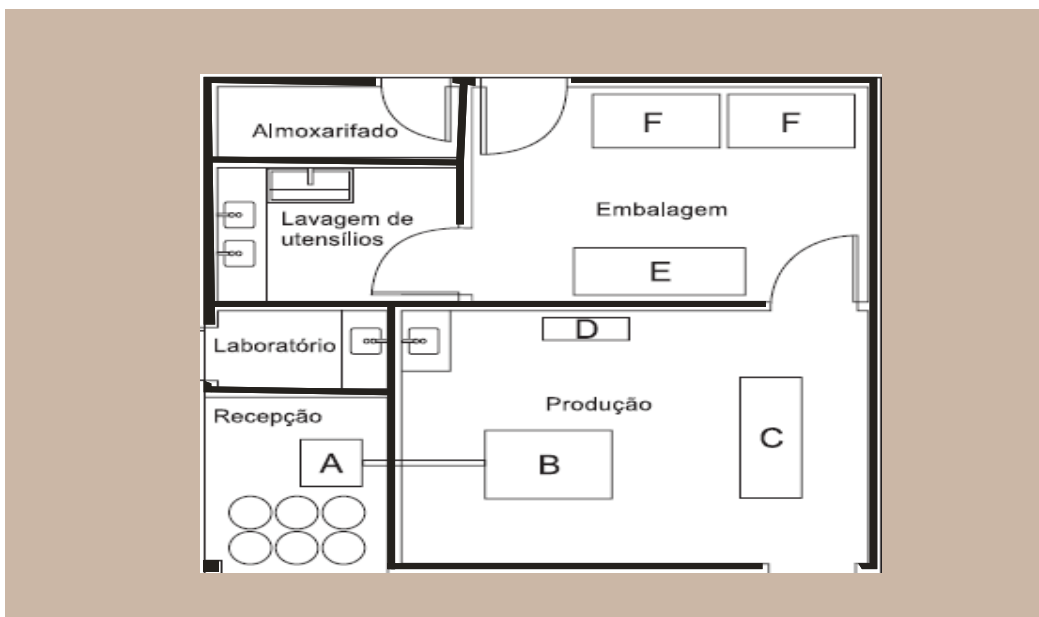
Planta baixa modelo de queijaria de queijo de coalho – Embrapa, 2006.
